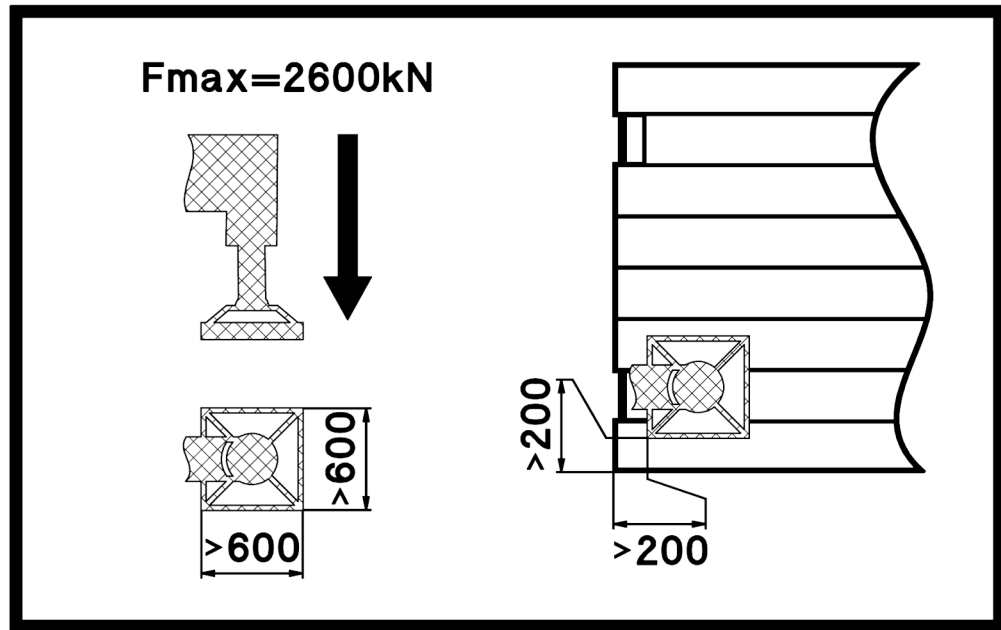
La placa de apoyo se coloca fuera del centro en la plancha de apoyo
